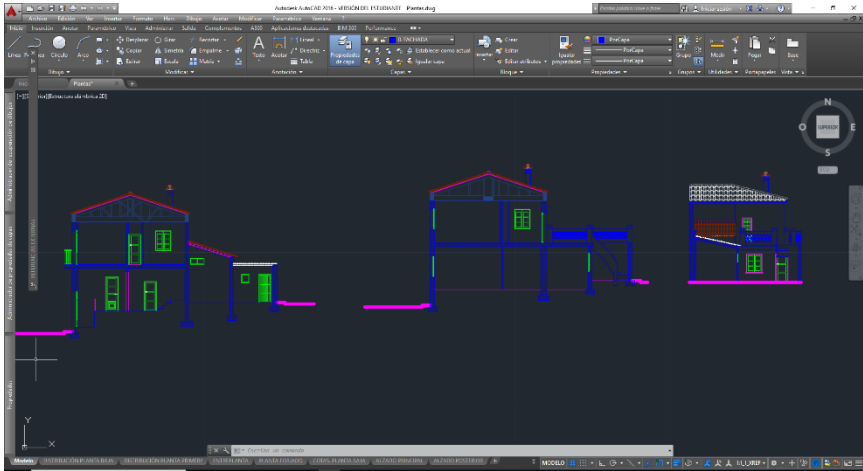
Levantado de Planos de Sección en AutoCad. Fuente Propia.
